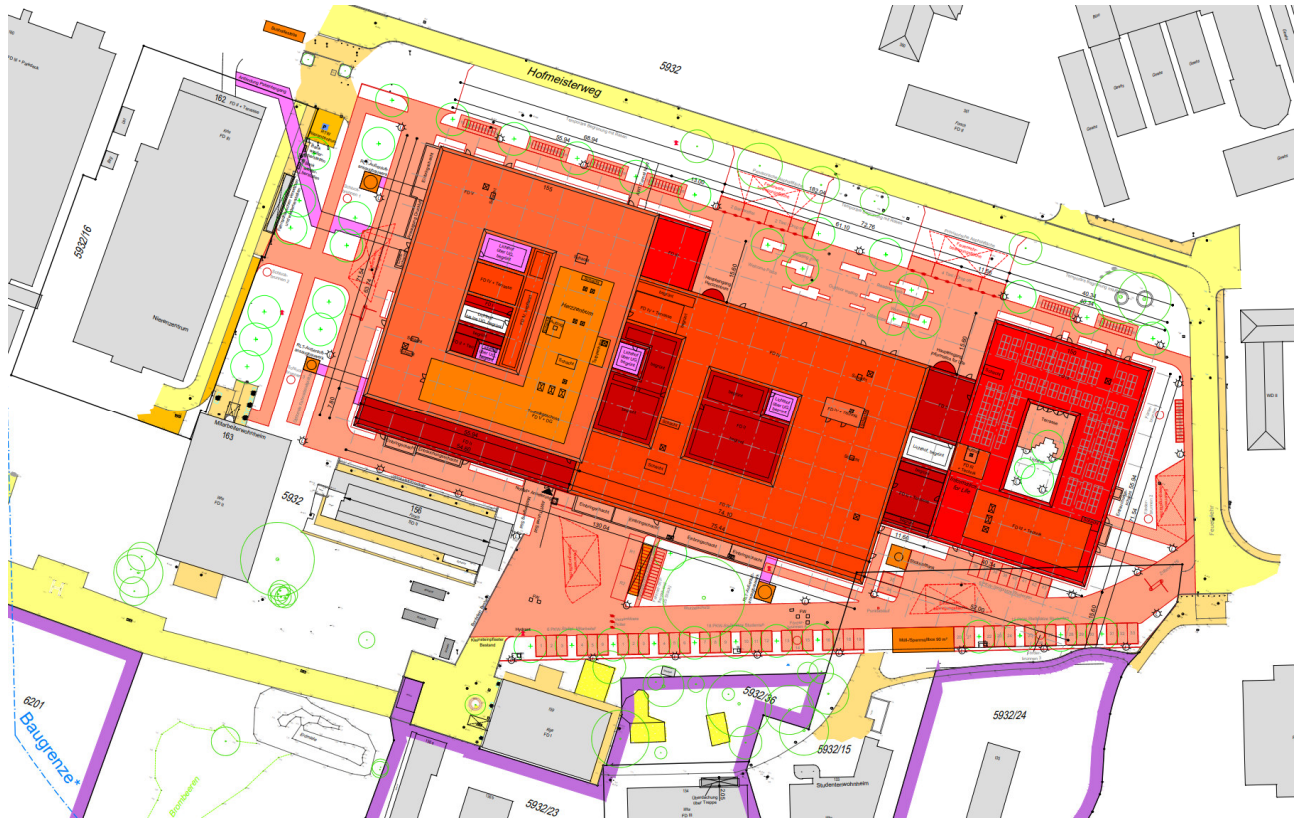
Lageplan Projektphase 2 / Lageplan Bauantrag 16.05.2024
